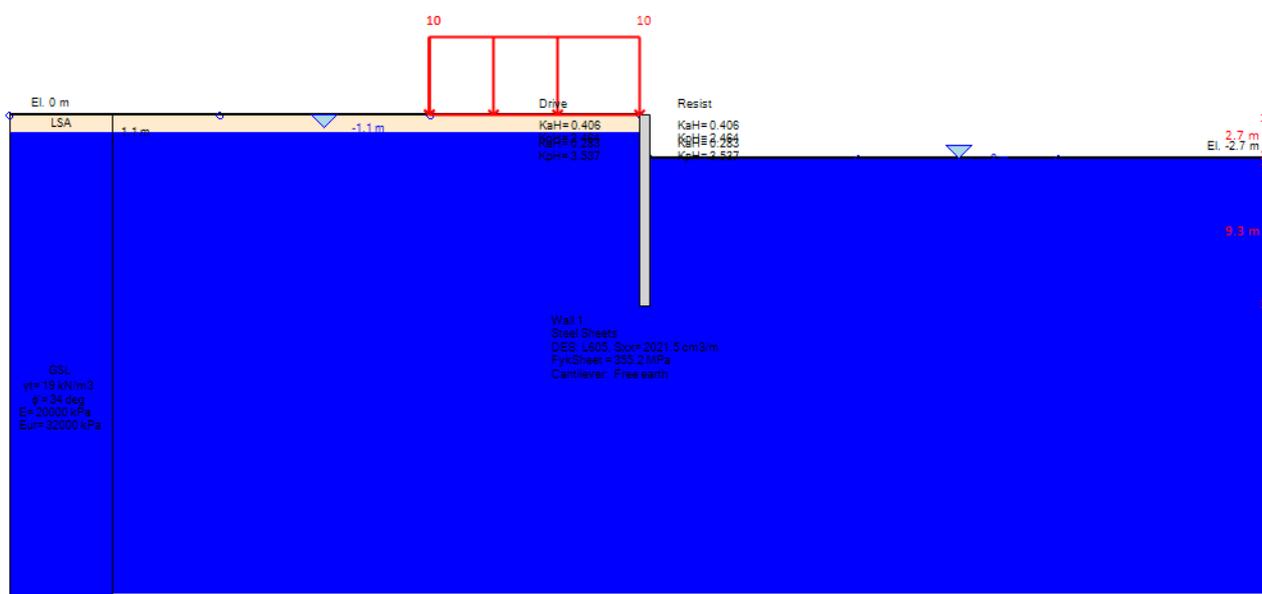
Modello di calcolo_ Spalla SP1
